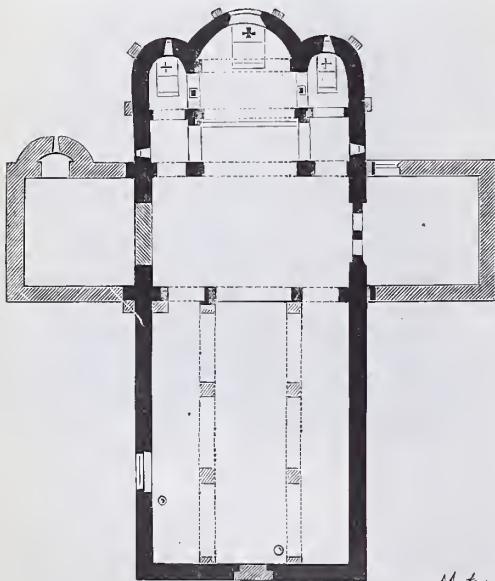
Kirche von S. Generouc. Grundriss.
